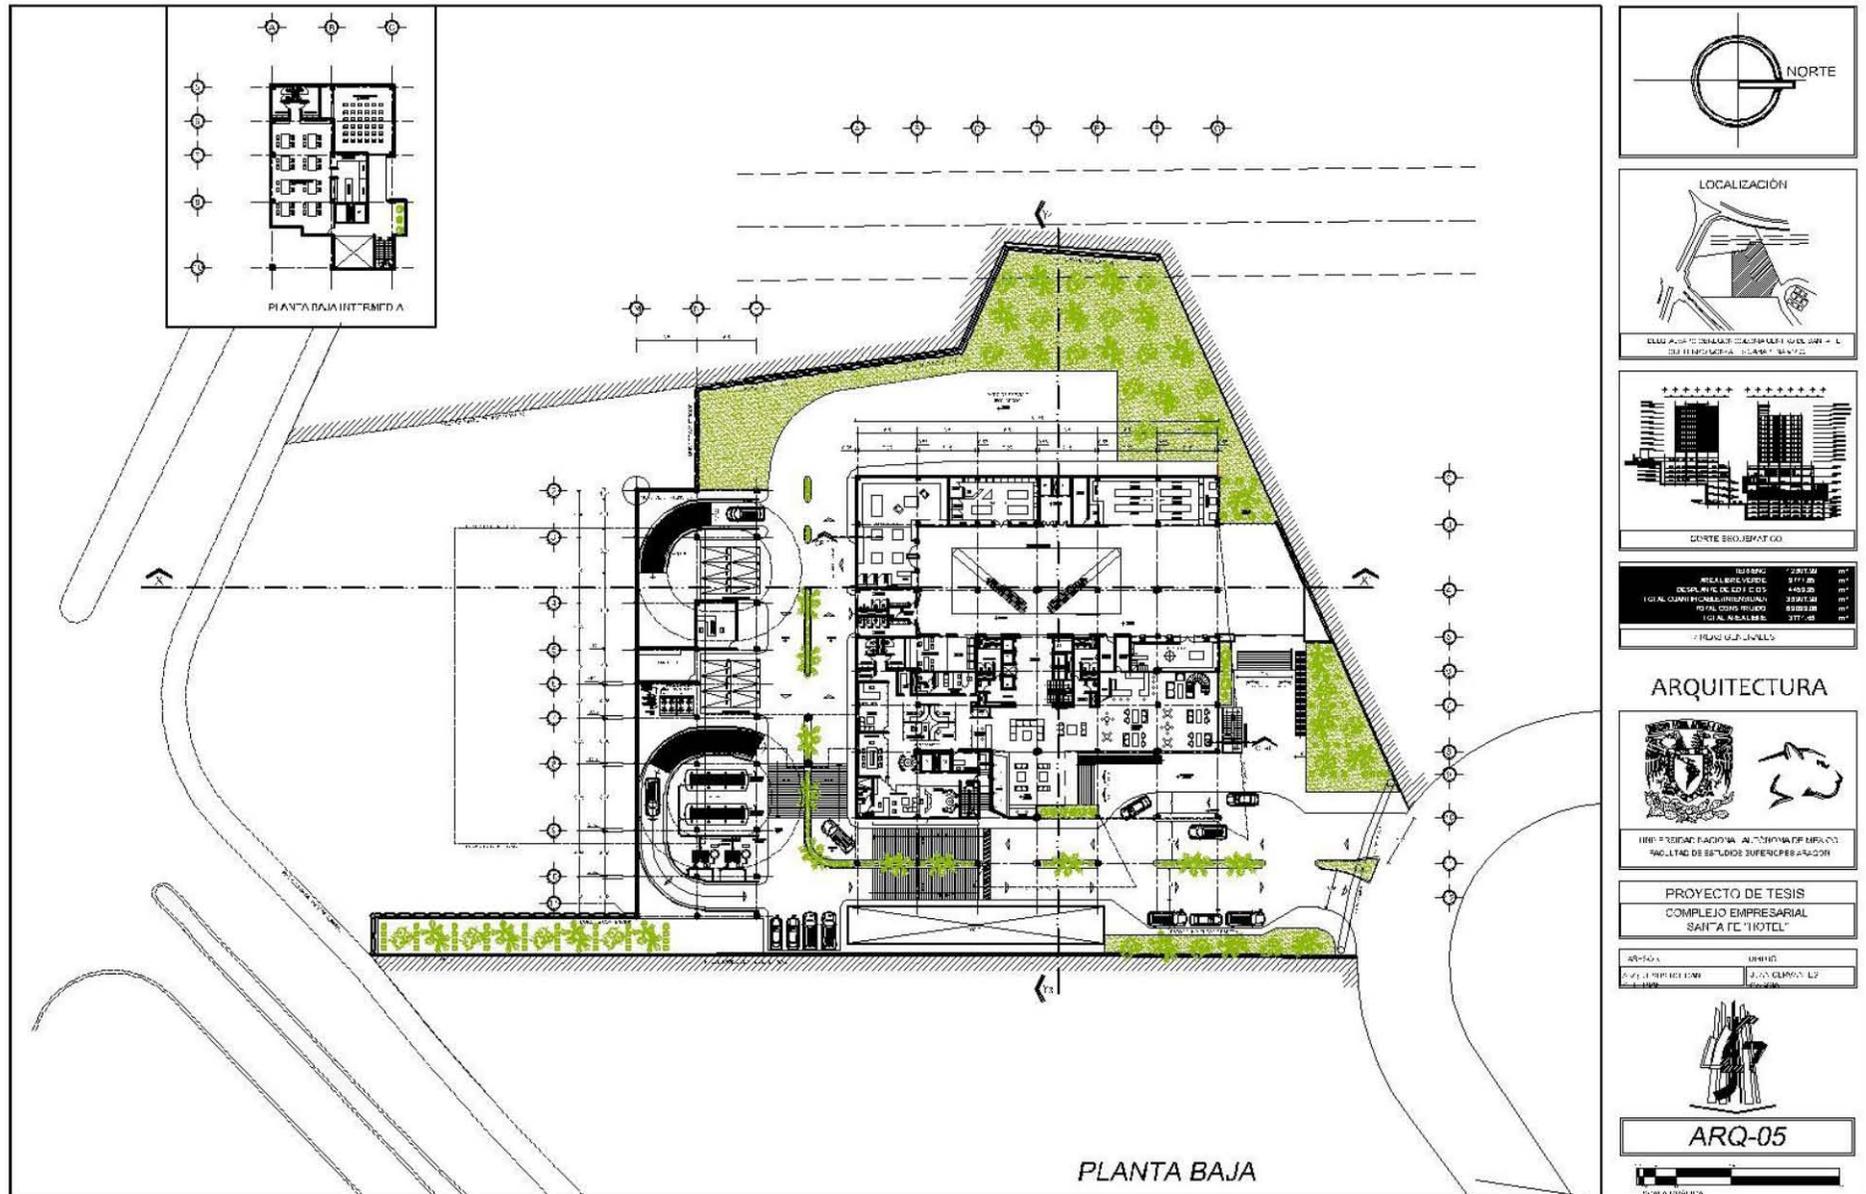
Plano ARQ-05; Planta Baja Hotel/Centro Comercial. Edición propia.
